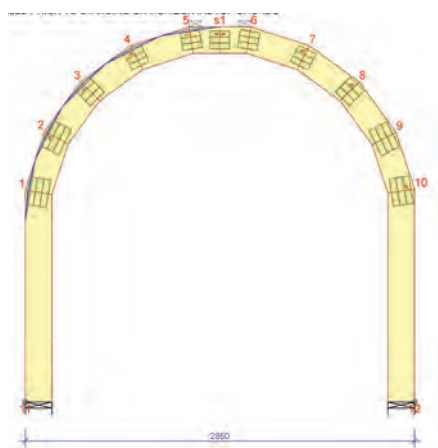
przedstawia konstrukcję dachu łukowego. Kształt dachu i profil ruchu opracowuje architekt. Na podstawie
